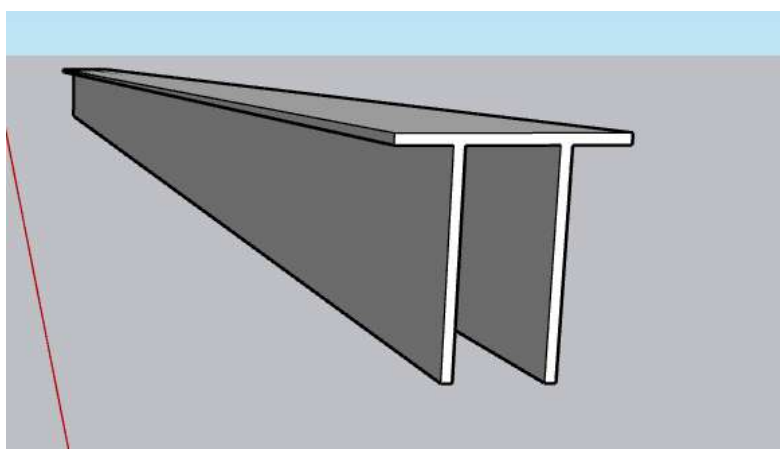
modelo de acabamento metálico de aço juntas de dilatação
